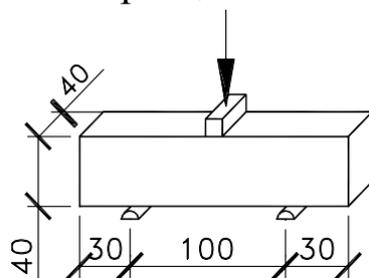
Схема испытания гипсовой балочки на изгиб
